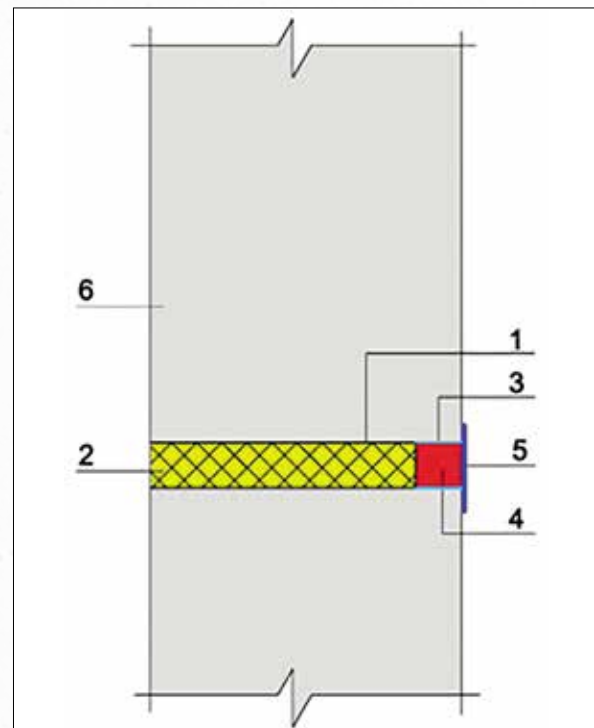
Общая схема гидроизоляции отверстий от стяжек опалубки
